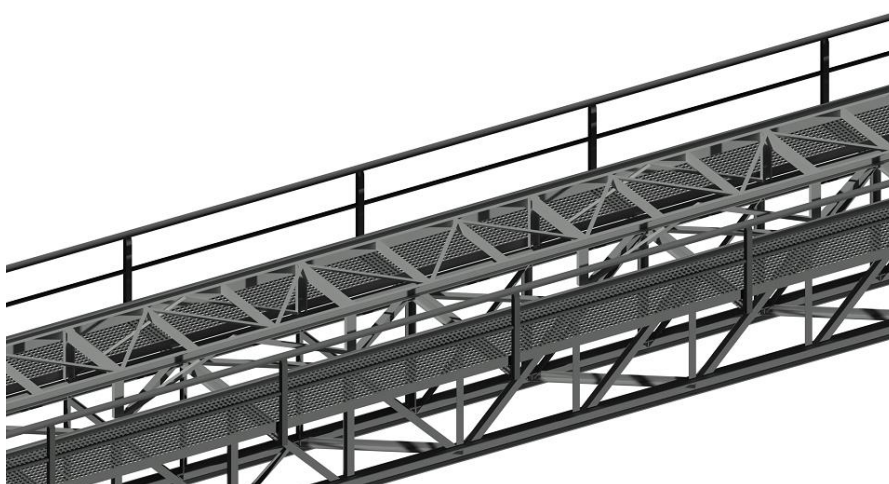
Conjunto das Estruturas Principal e Secundária
